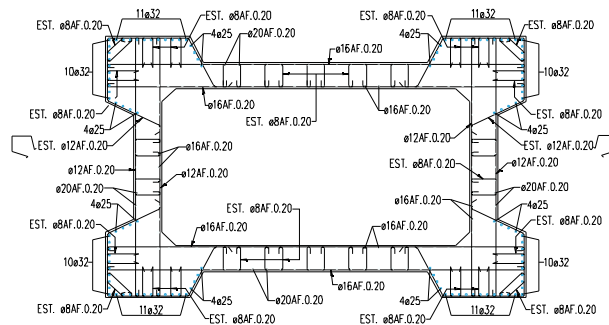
Armadura longitudinal e transversal dos pilares P6, P7 e P8.
